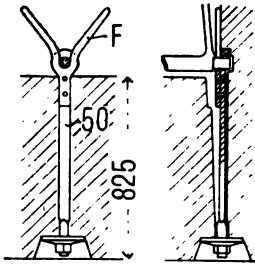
Führung des Vorderzapfens an den Mainwehren.
